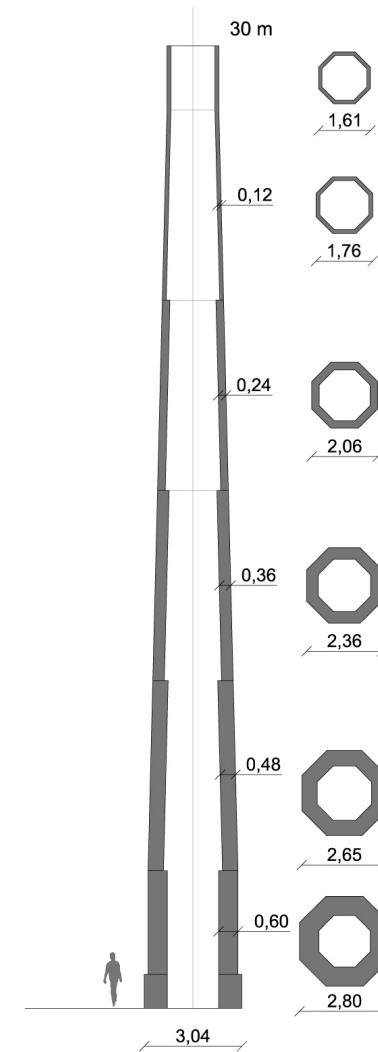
Sección de un fuste de chimenea de aproximadamente 30 metros, donde se observa el cambio de sección
